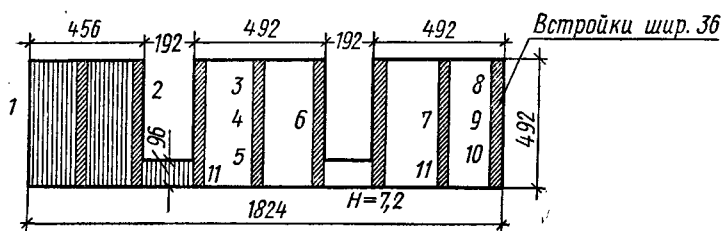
Схематический план главного корпуса Волжского автозавода:
